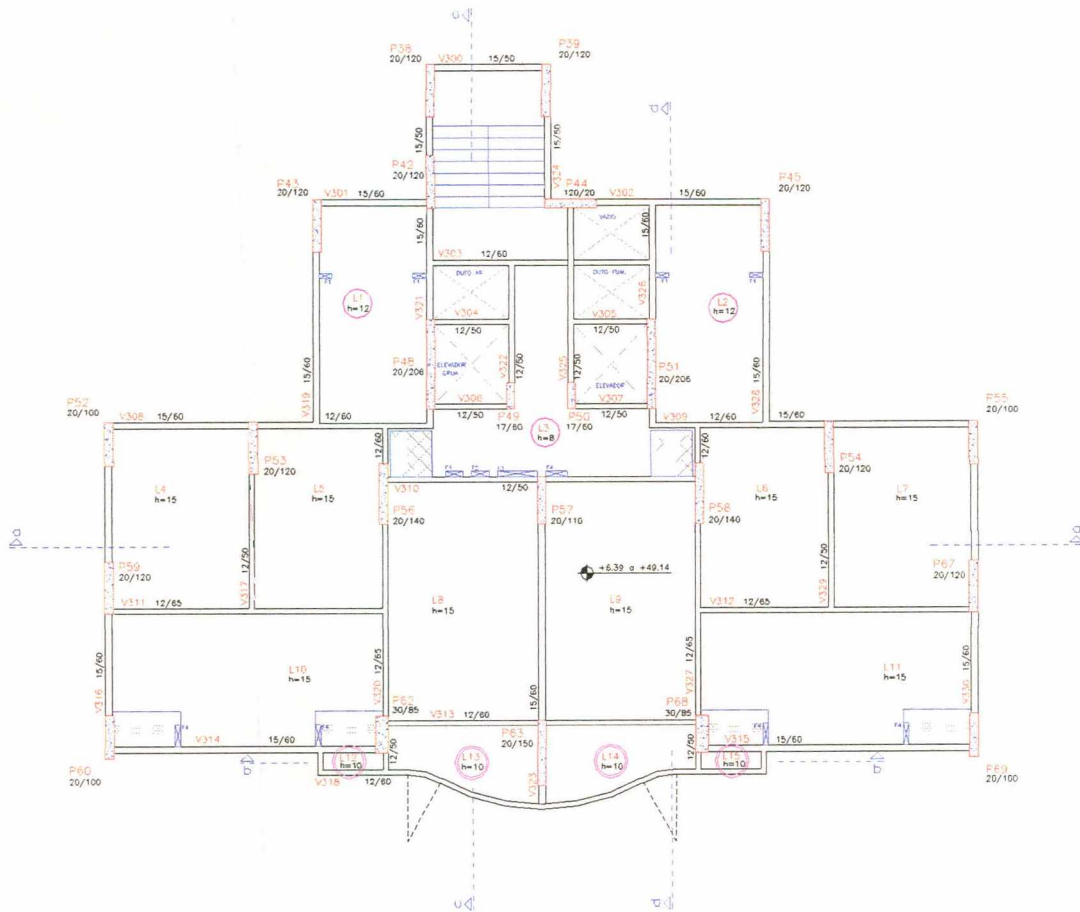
Planta de fôrma do edifício 17ENT1
